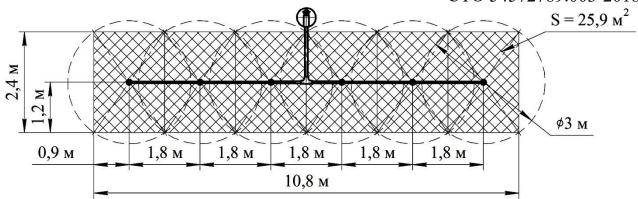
Вариант трубной разводки по вписанным прямоугольникам на 6 насадков-распылителей
